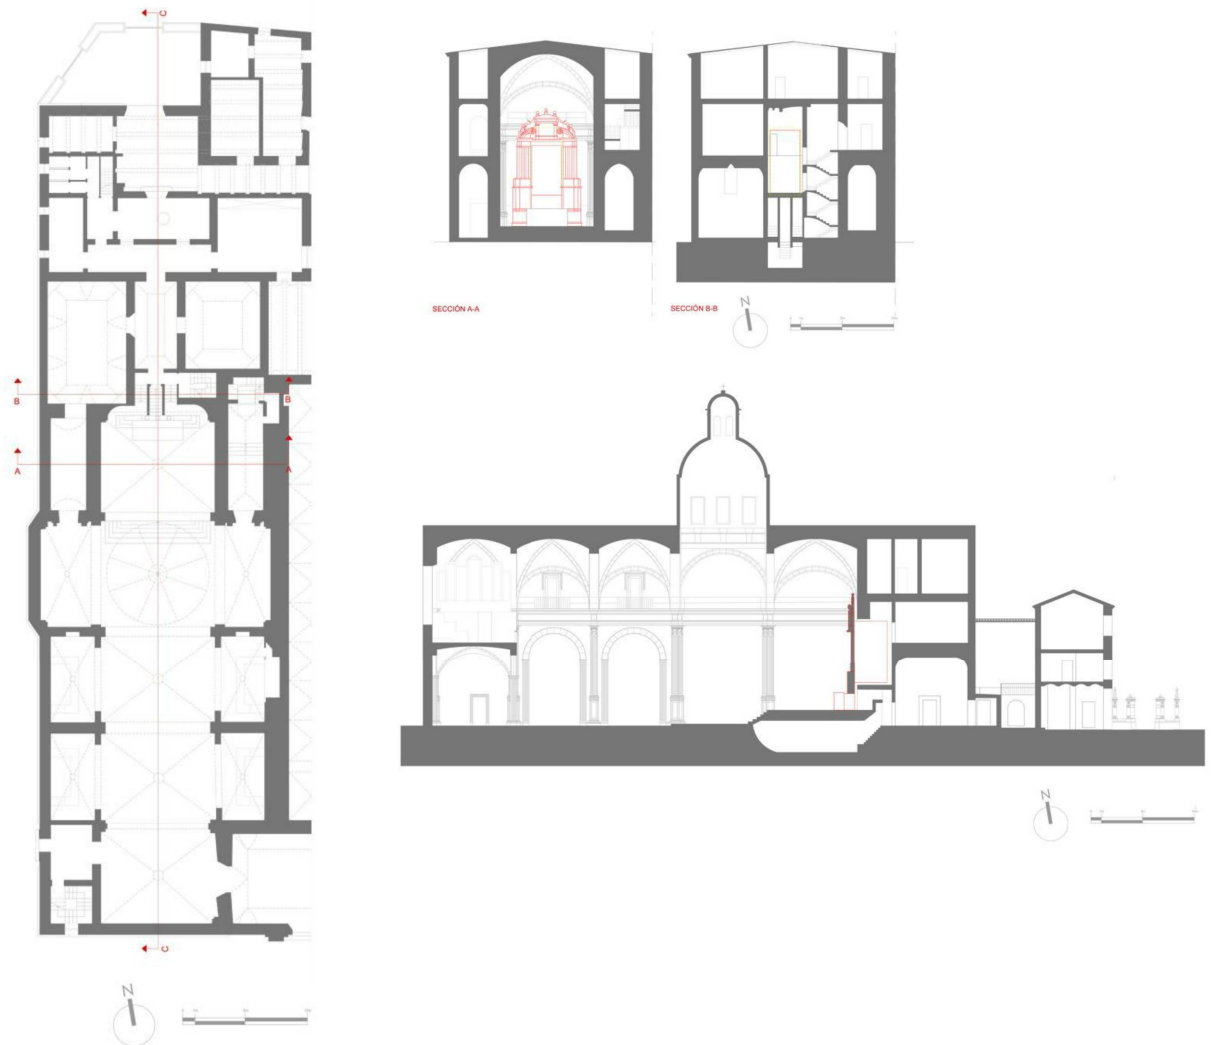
Planta de la Iglesia y secciones, donde se aprecia el hueco del retablo en el muro
